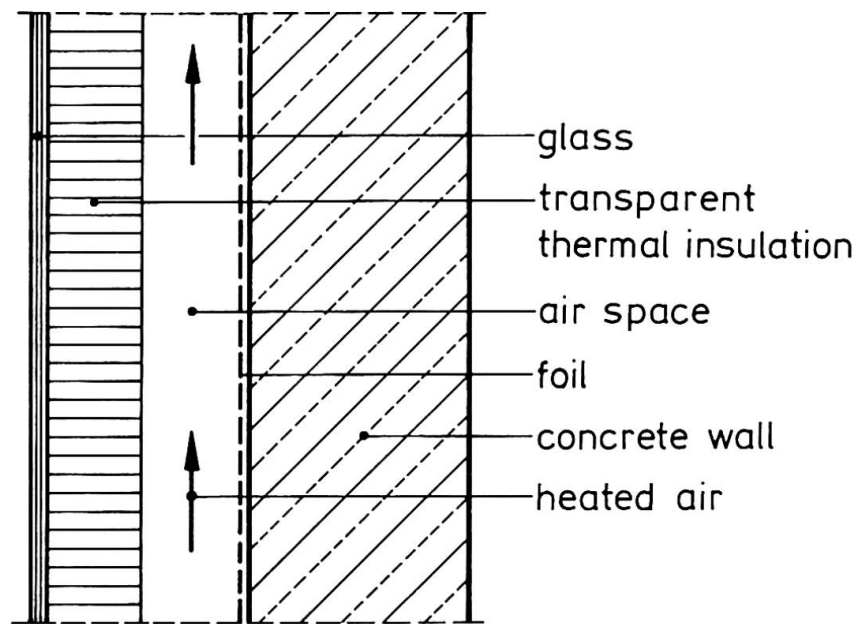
Wandaufbau mit einer transparenten Wärmedämmung
